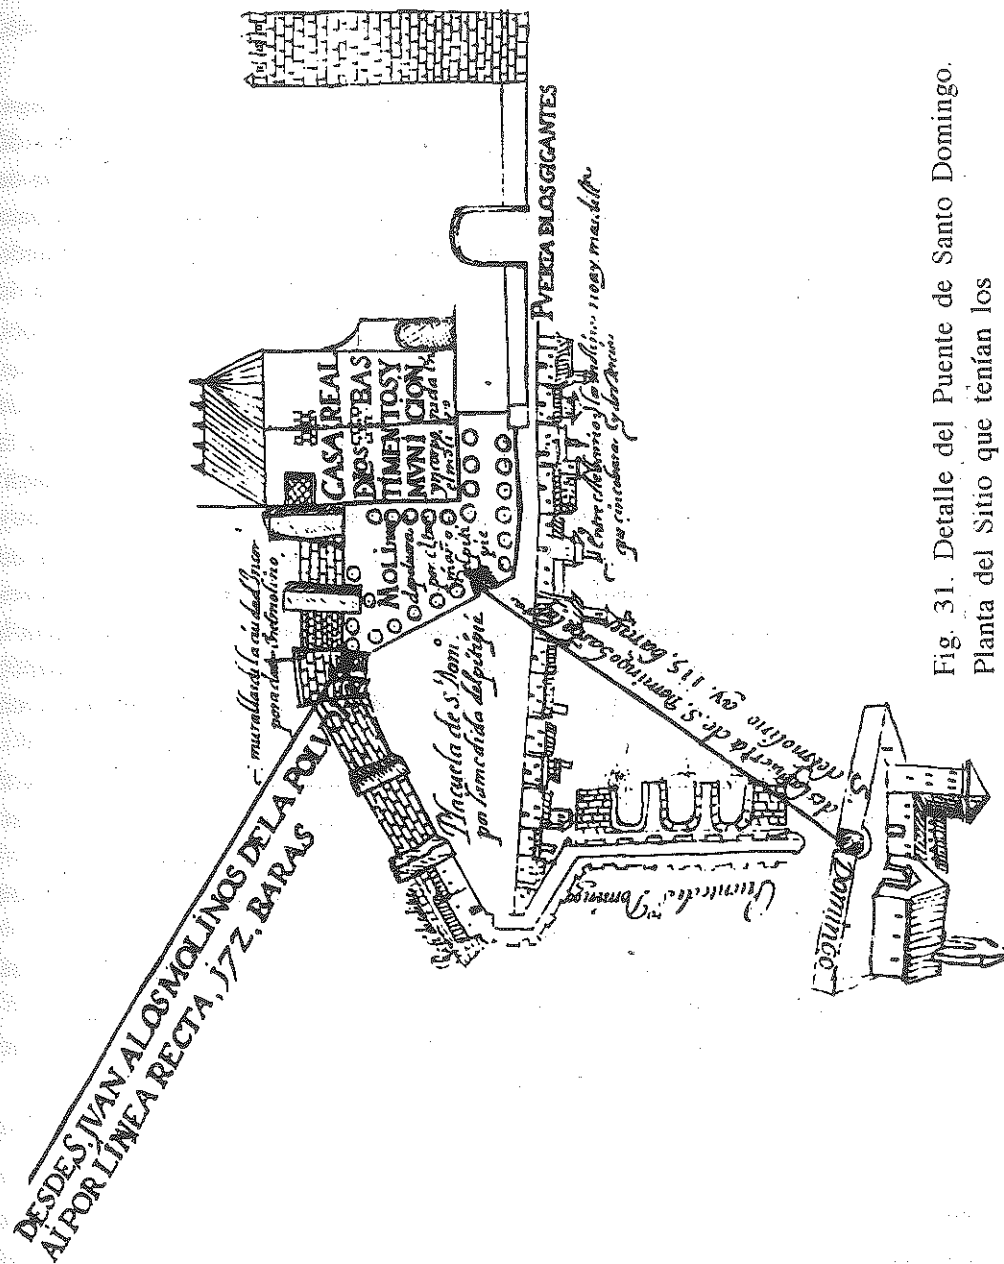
Detalle del Puente de Santo Domingo. Planta del Sitio que tenían los Molinos viejos de Pólvora en Málaga. 1620.
